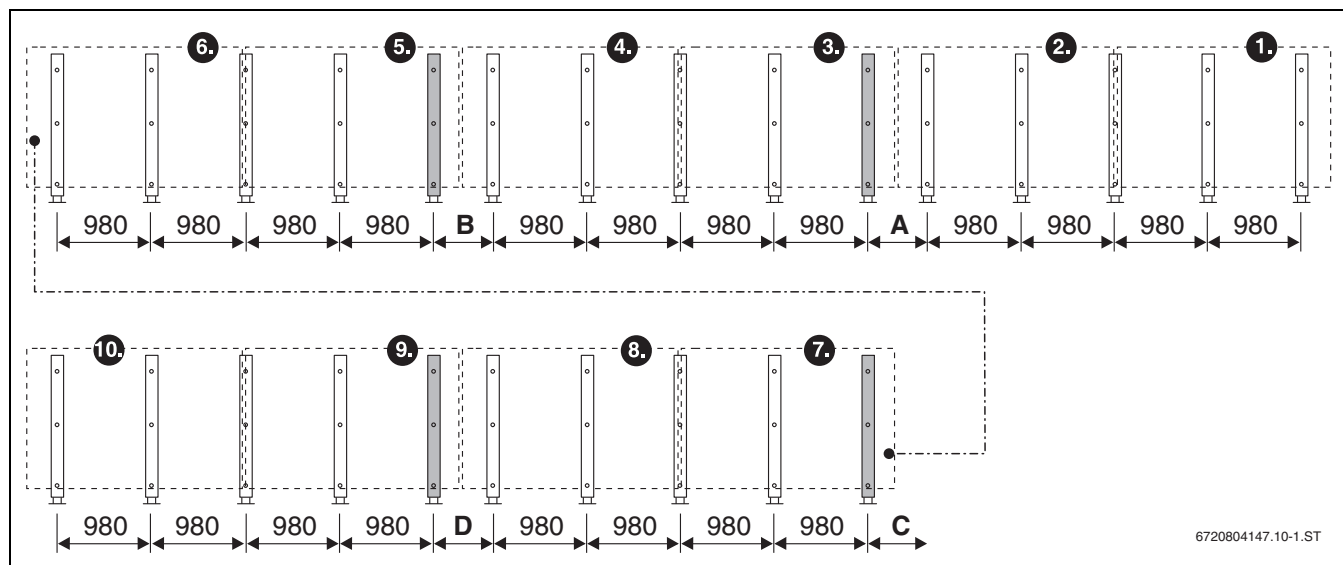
Uitvoering voor hogere belastingen, 2 horizontale collectoren, hellingshoek 30° (voetverankering)
